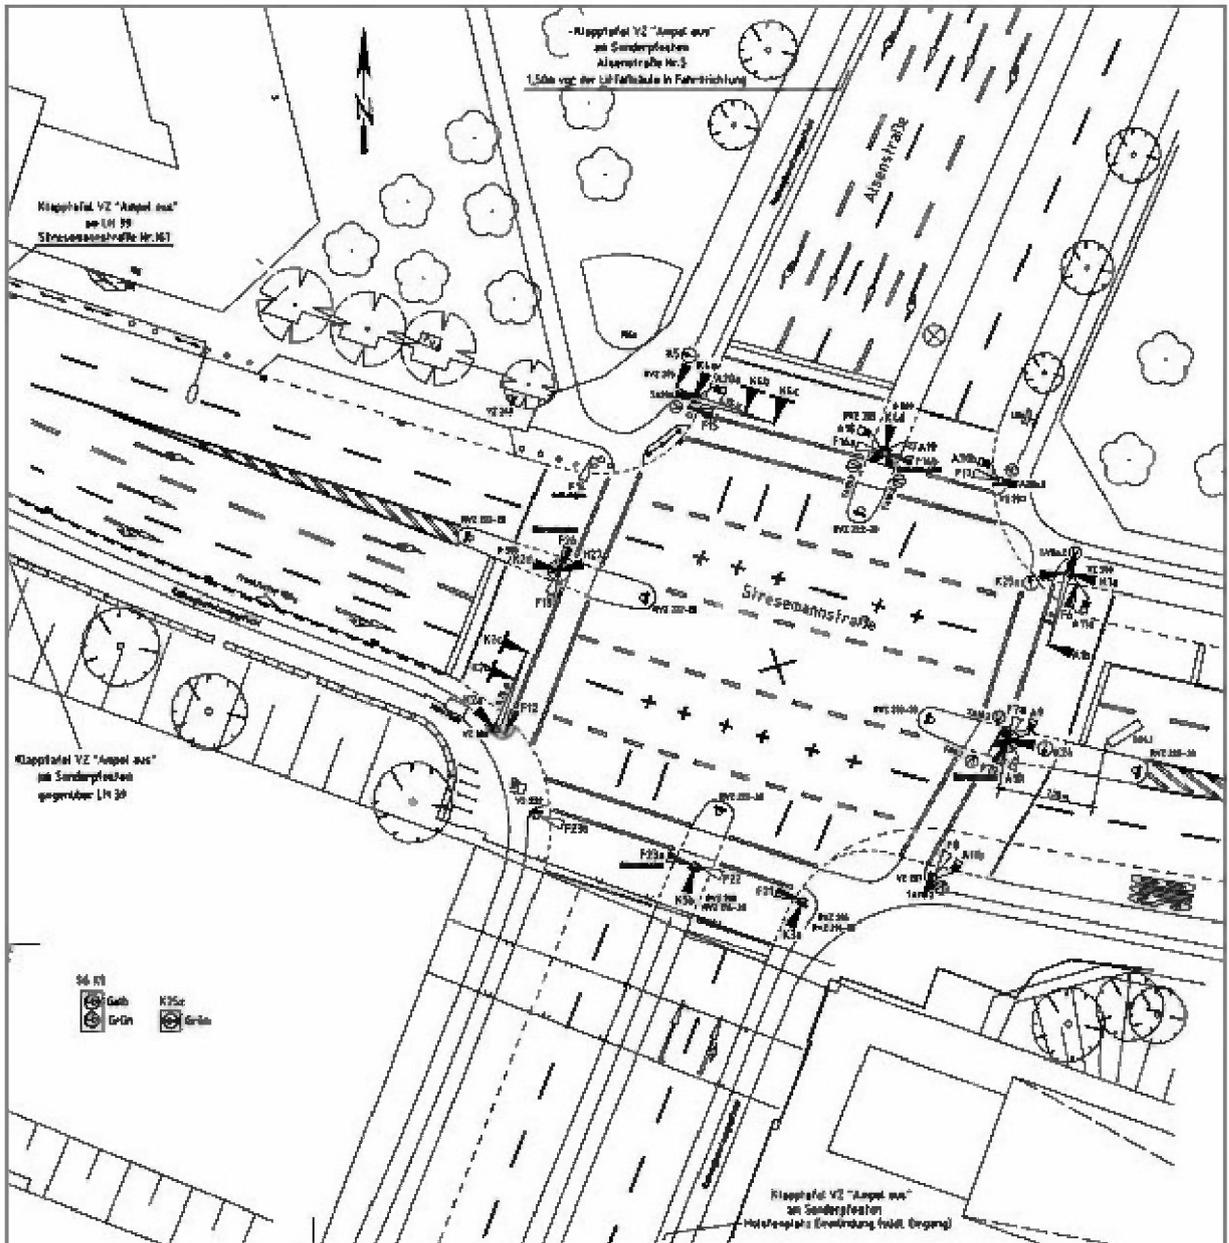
2 Signallageplanausschnitt LSA 153
